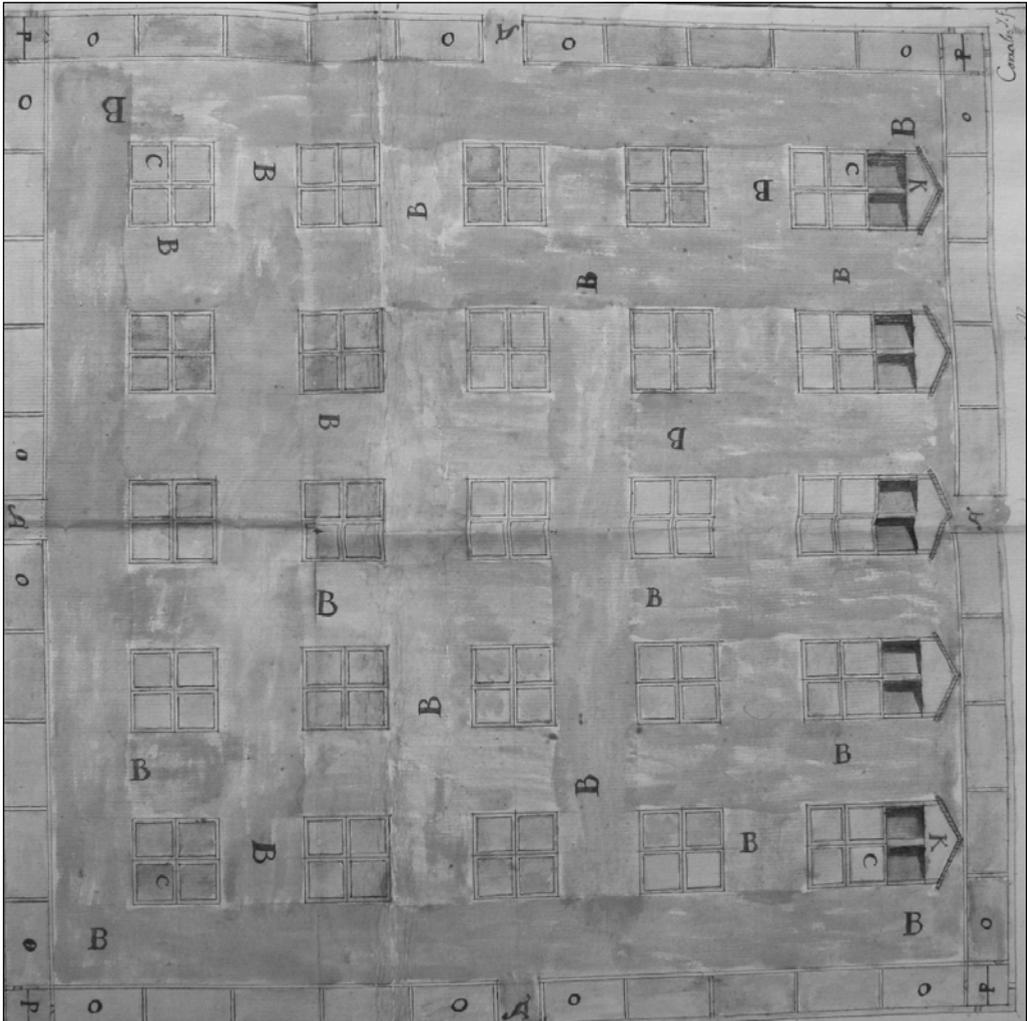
Albacete. Plano del recinto interior donde aparece la planta y alzado de las casetas, formadas por cuatro casillas así como su distribución. Recuerda al trazado de un campamento romano.
